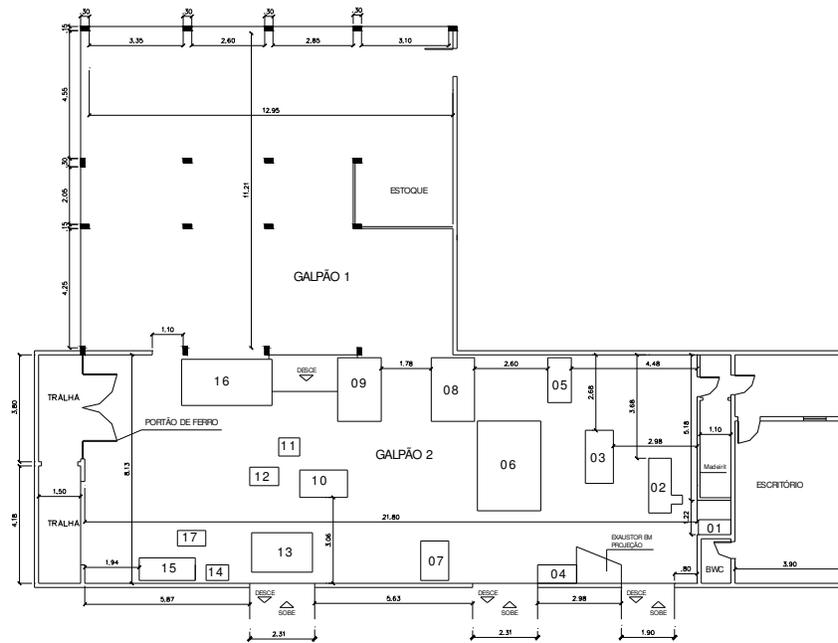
Planta baixa 3: Galpão 1 e 2 com antigo lay-out sem a o refeitório. (Equipe de Projeto).
